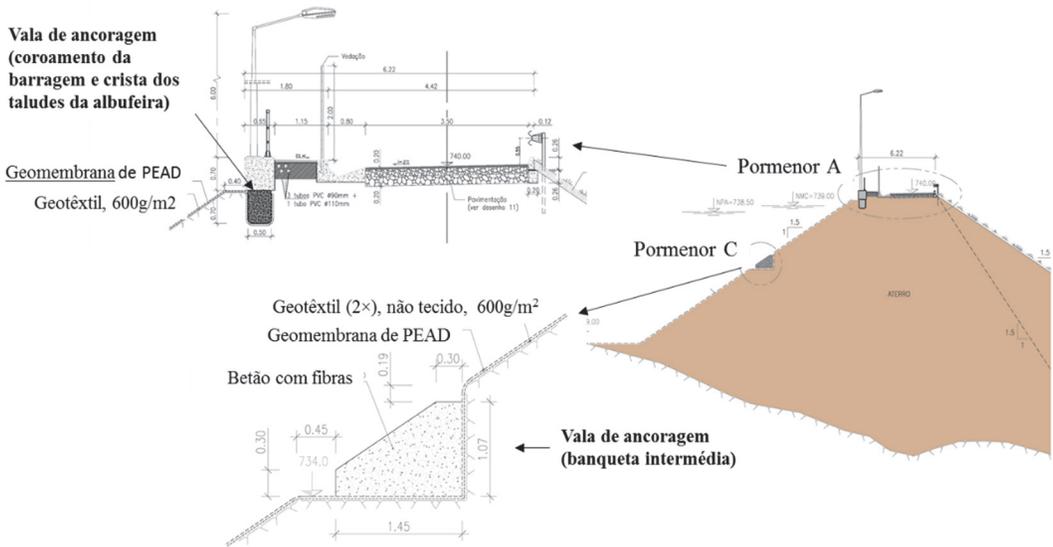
Sistema de ancoragens na barragem da Portela.
